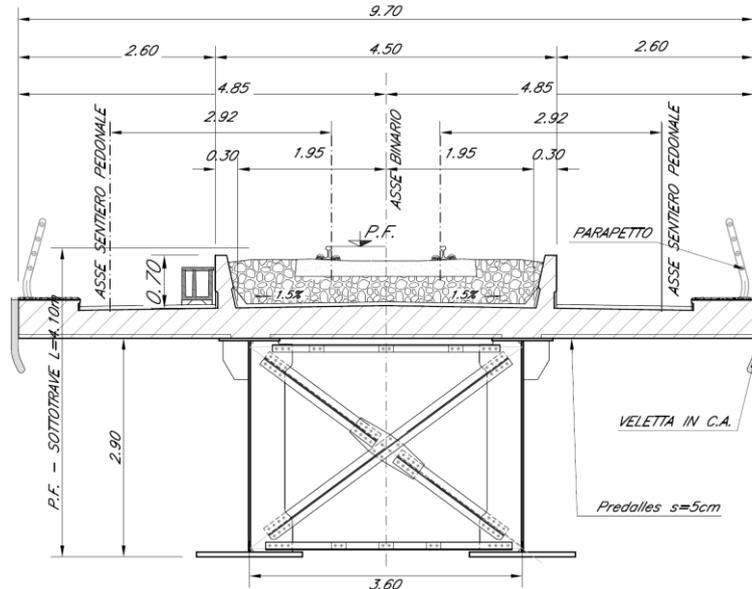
Sezione trasversale campate in acciaio-cls L=40 m
